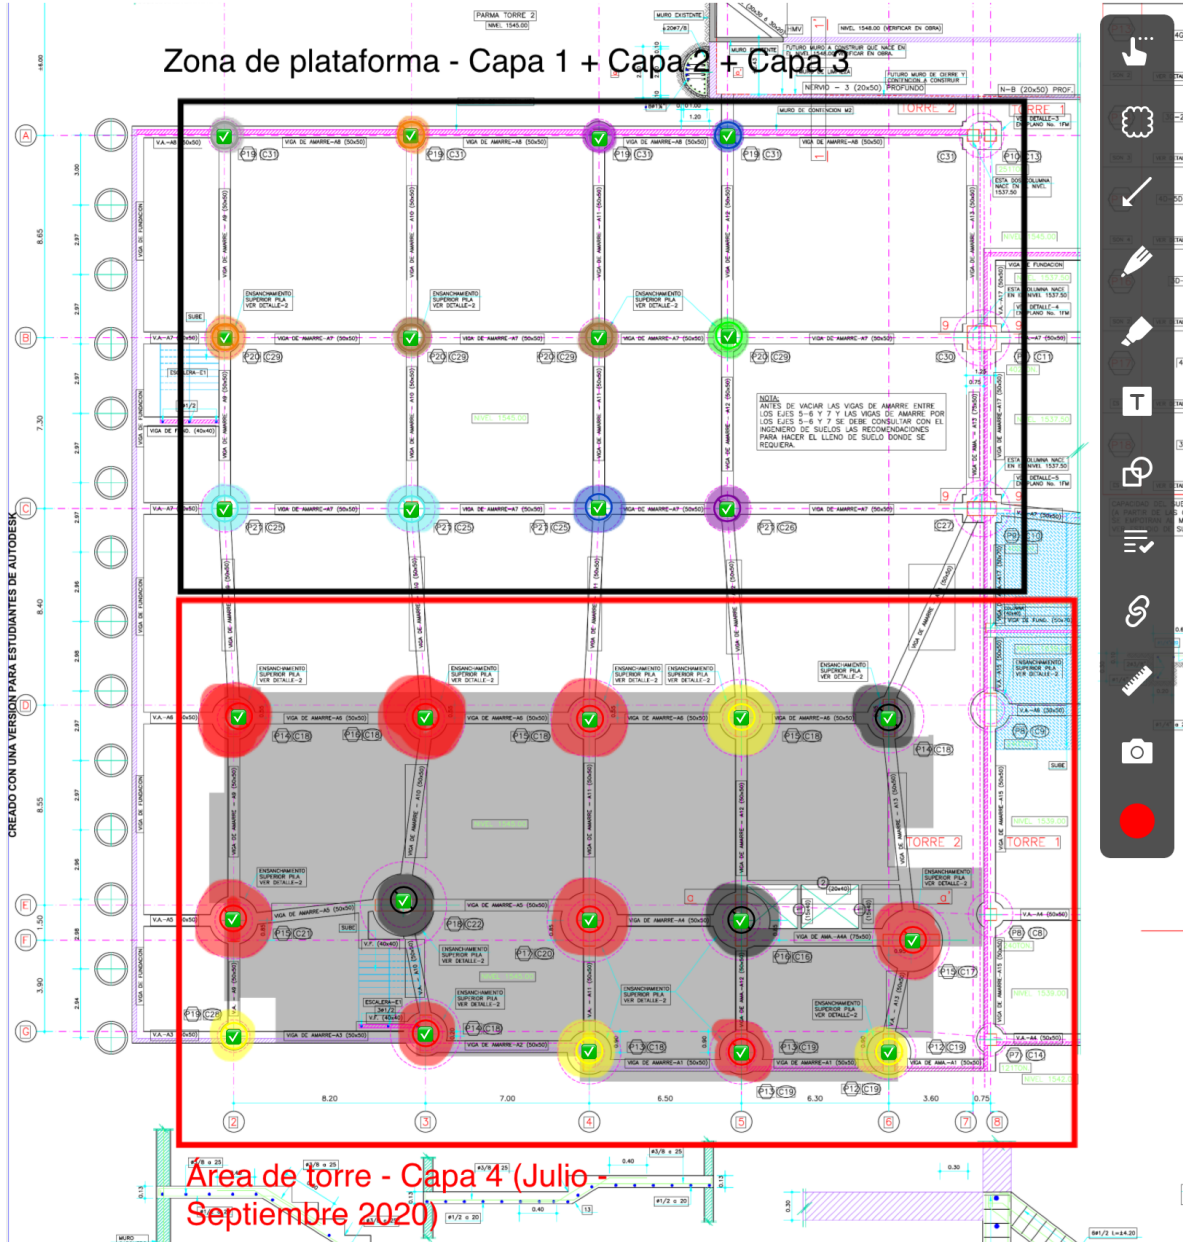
Excavación y vaciado del cuarto lote de pilas: Zona torre.
